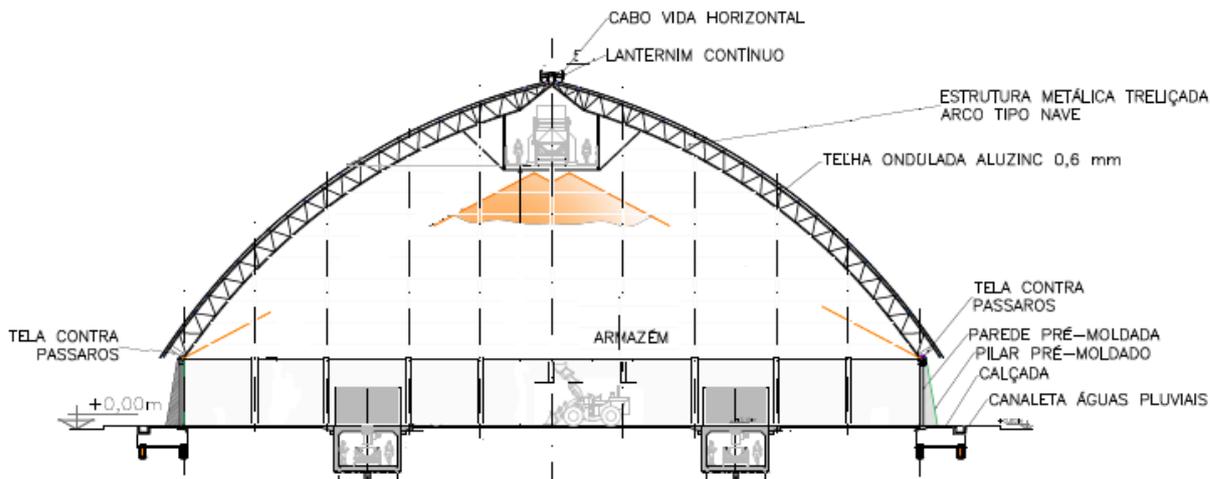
Corte Transversal do Armazém Novo 182.000 toneladas
